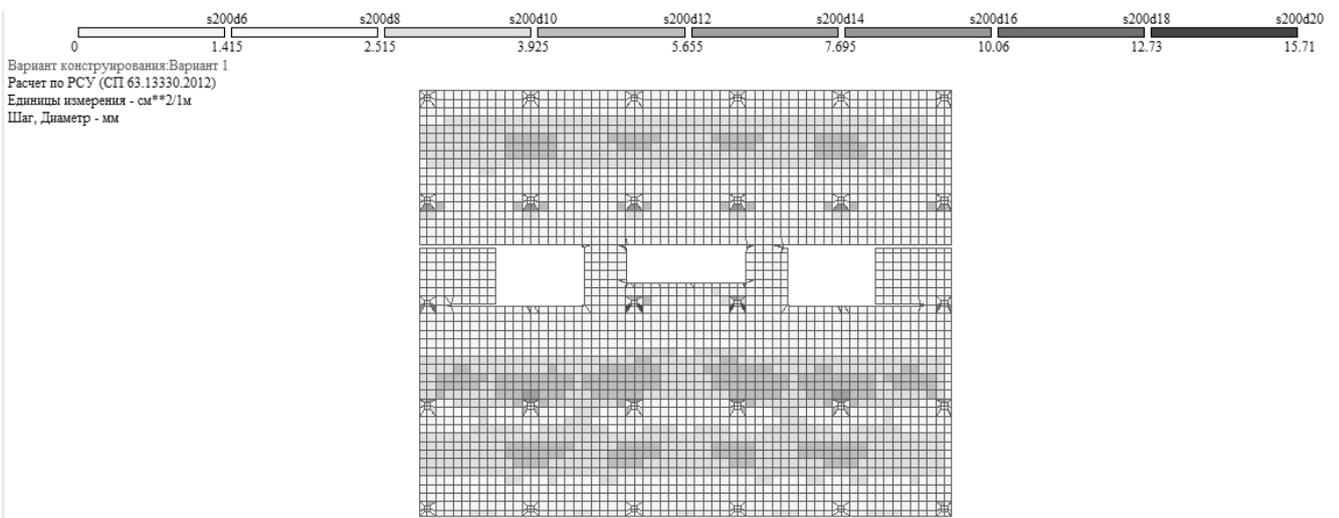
Нижнее армирование плиты перекрытия по оси Y
